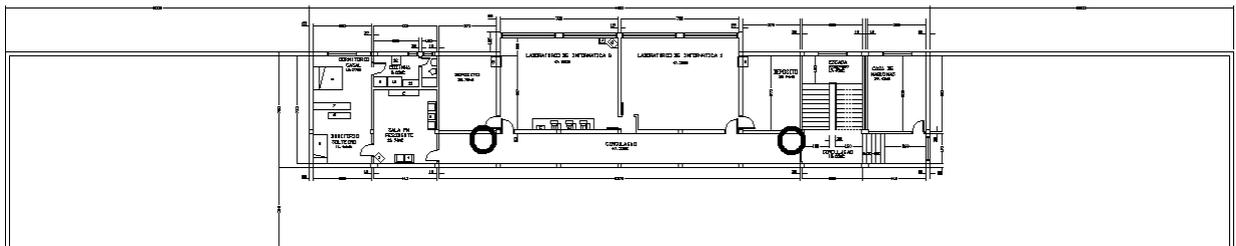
Localização recomendada para as tomadas de incêndio do quinto pavimento.
